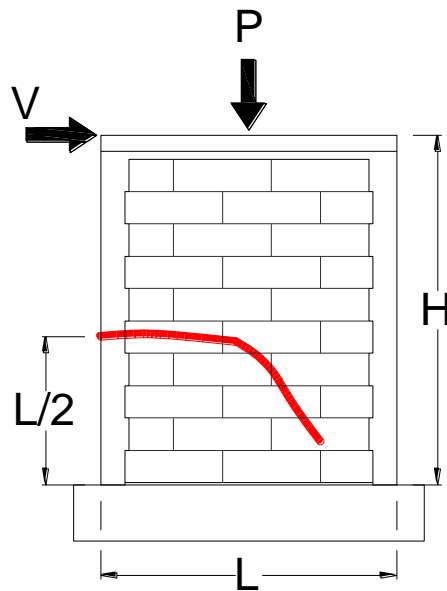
Grieta de flexo-cortante en un muro confinado
